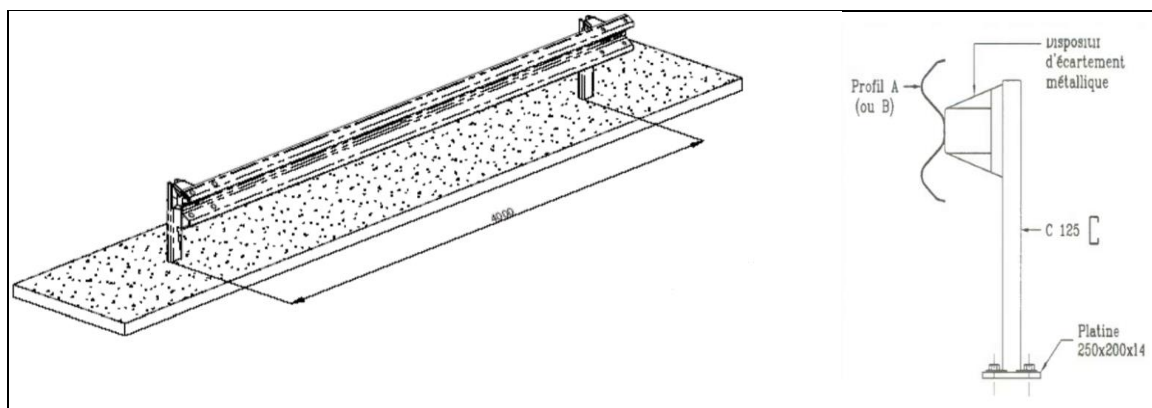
Coupe transversale et disposition longitudinale type GS4 sur platine
